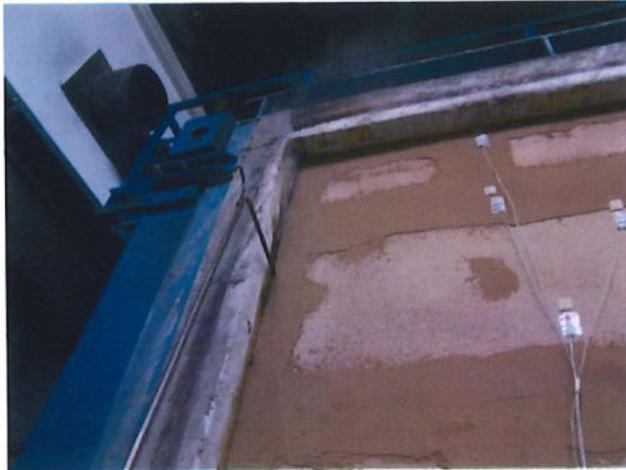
Prüfminute 77, Messung mit dem Handelement am linken Wandanschluss.
